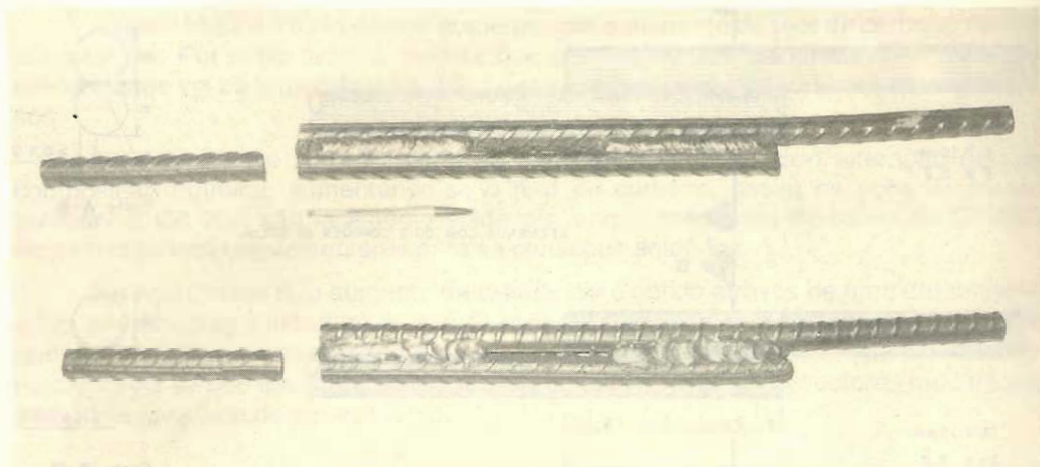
Solda por transpasse, com deposição de eletrodo com cordão, em um lado
